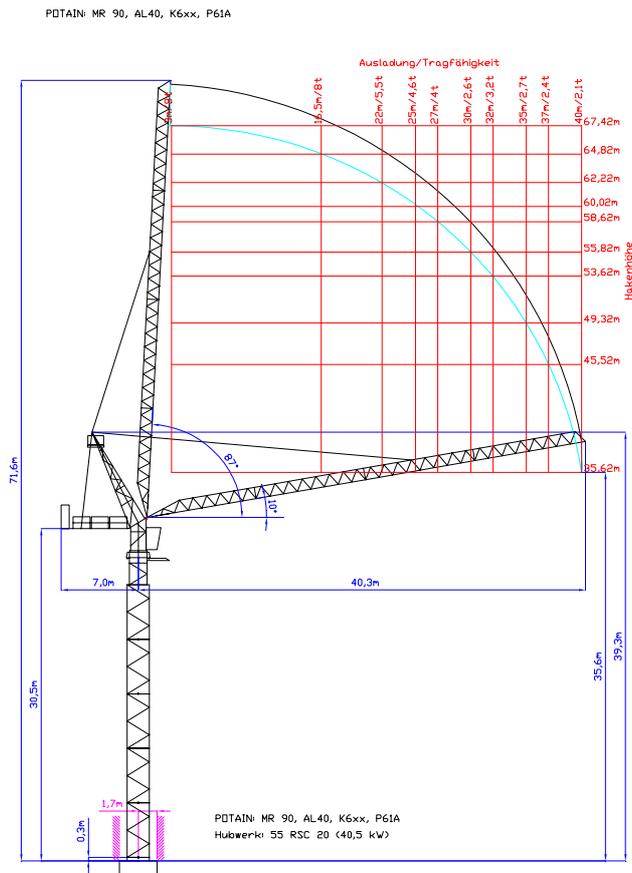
Oben drehender Wippausleger in der Seitenansicht
